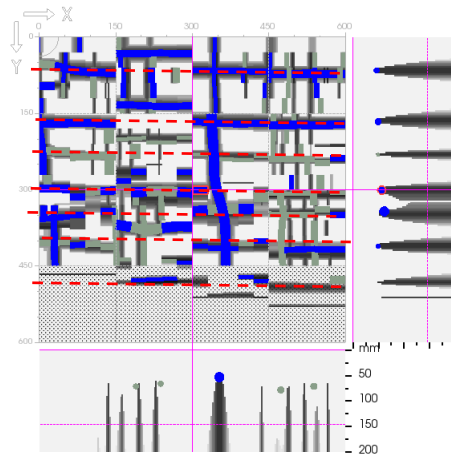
Poutre Pt02 – Travée 4 à mi-travée
